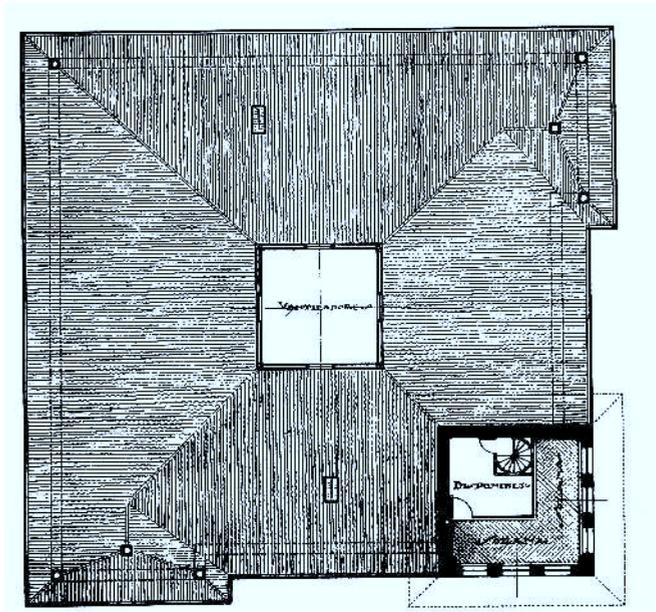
Proyecto para el Ayuntamiento de Carranza realizado en 1924 por el arquitecto Julio Sáenz de Barés. Planta de "entre cubiertas". (Edificio no construido).
